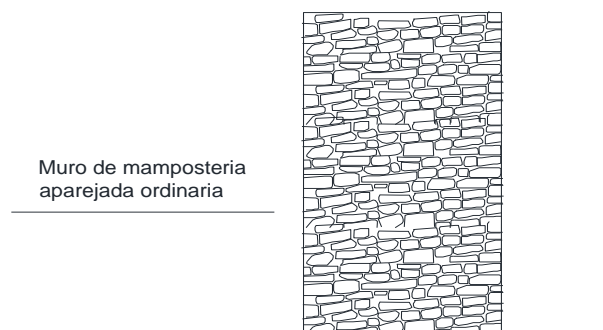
Croquis de muro de mampostería capillas San Francisco de Asís del Taxco el “Viejo”
